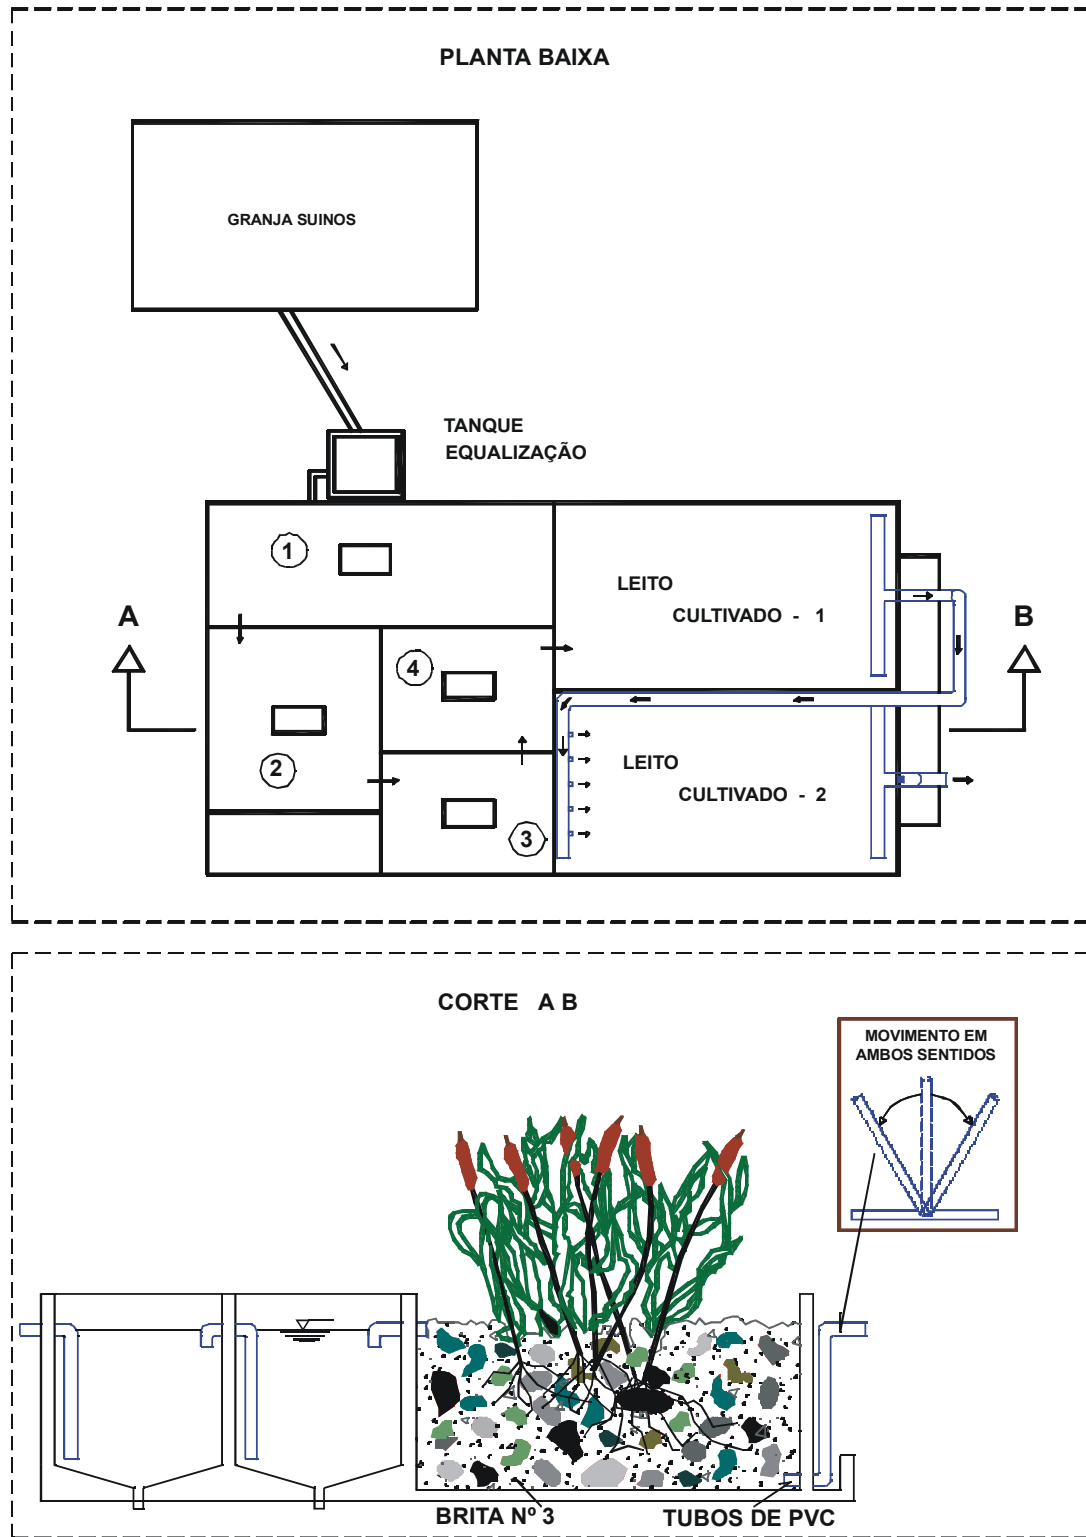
Desenho esquemático do sistema de tratamento, planta baixa e corte.
